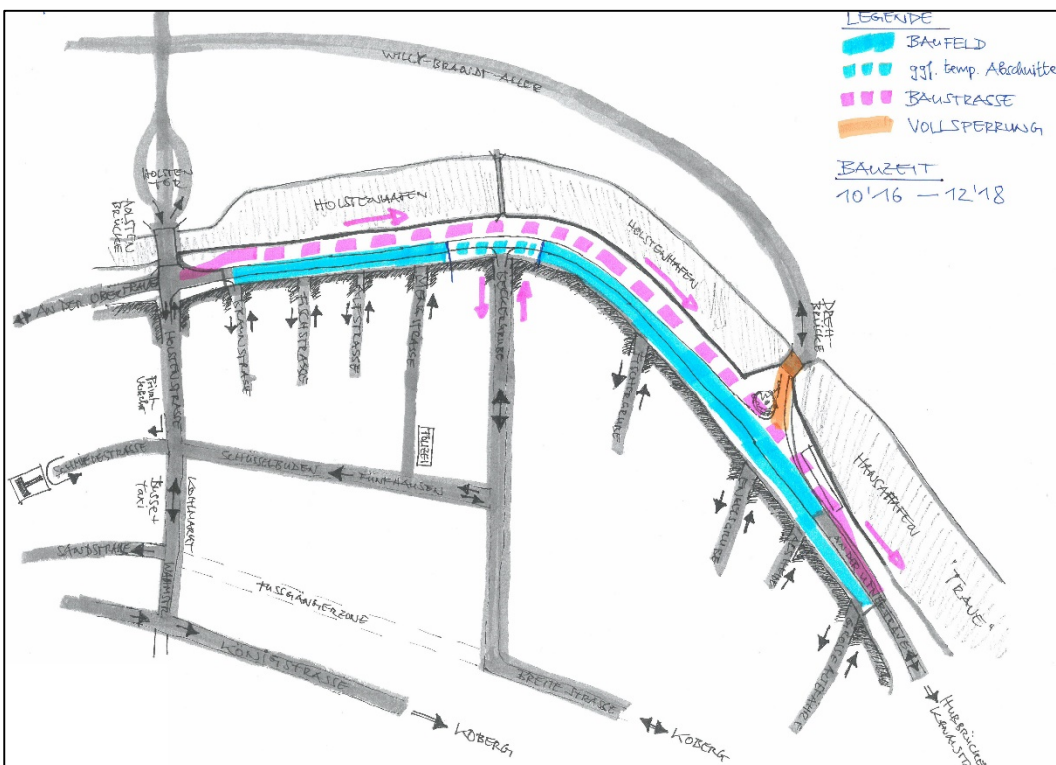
Schemaplan Bauablauf mit Baustraße | arge | zum Förderantrag 2016
